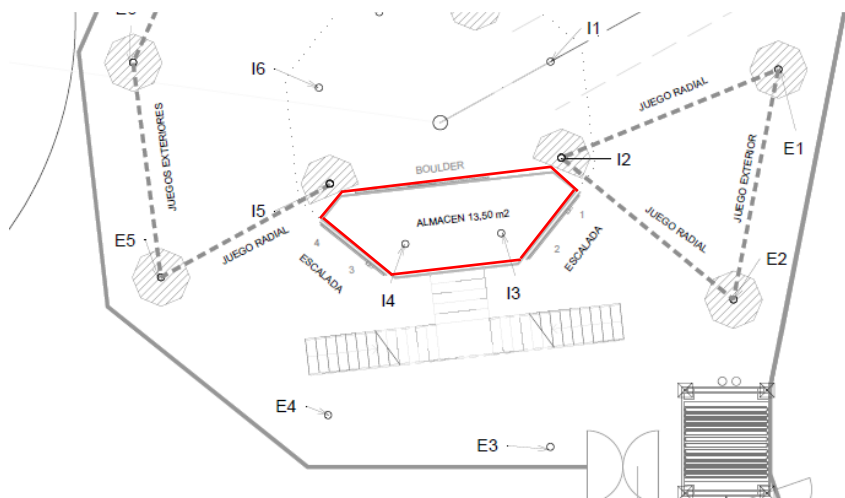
Almacén en planta baja. Fuente: Memoria de cálculo de la Torre Multiaventura
